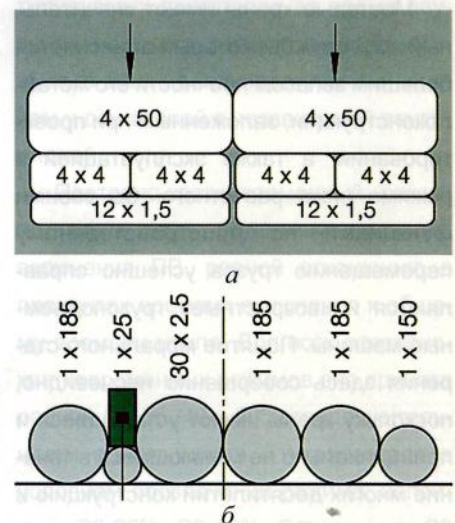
Укладка плоских (а) и круглых (б) кабелей
